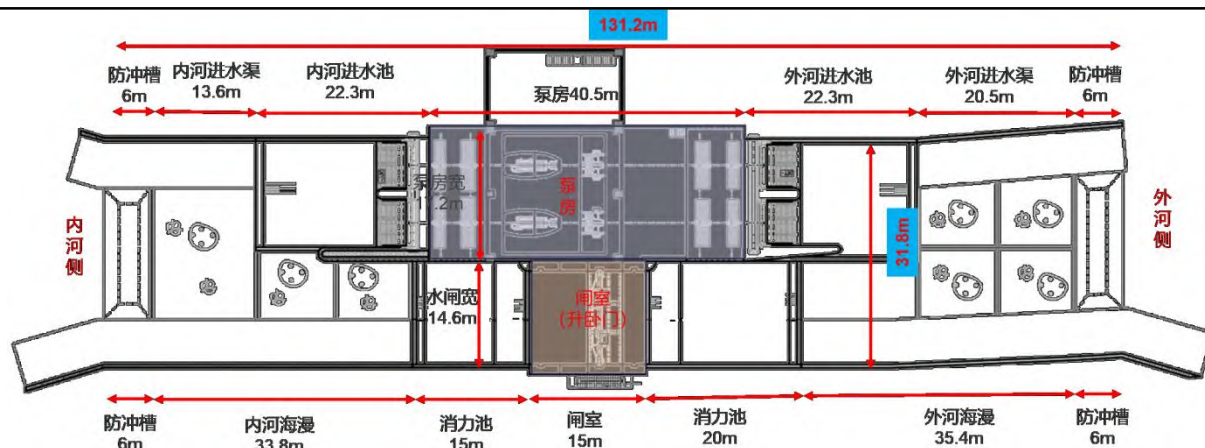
拟建北横泾南泵闸工程平面布置图
